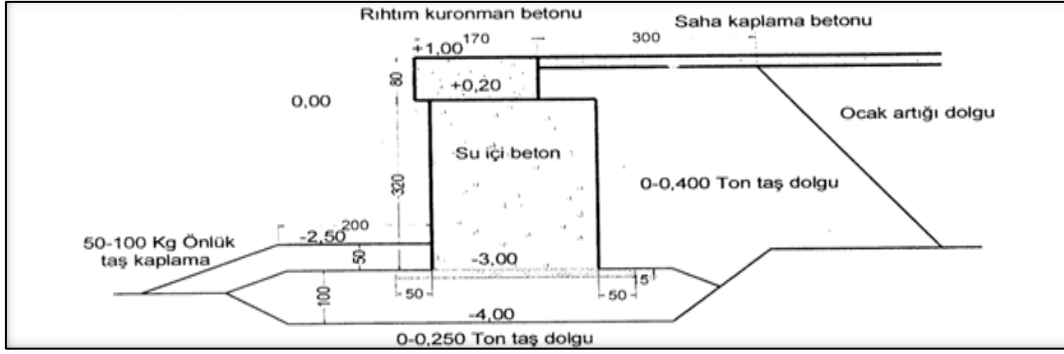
4.00 m lik beton bloklı rıhtımlar kesiti [16]
